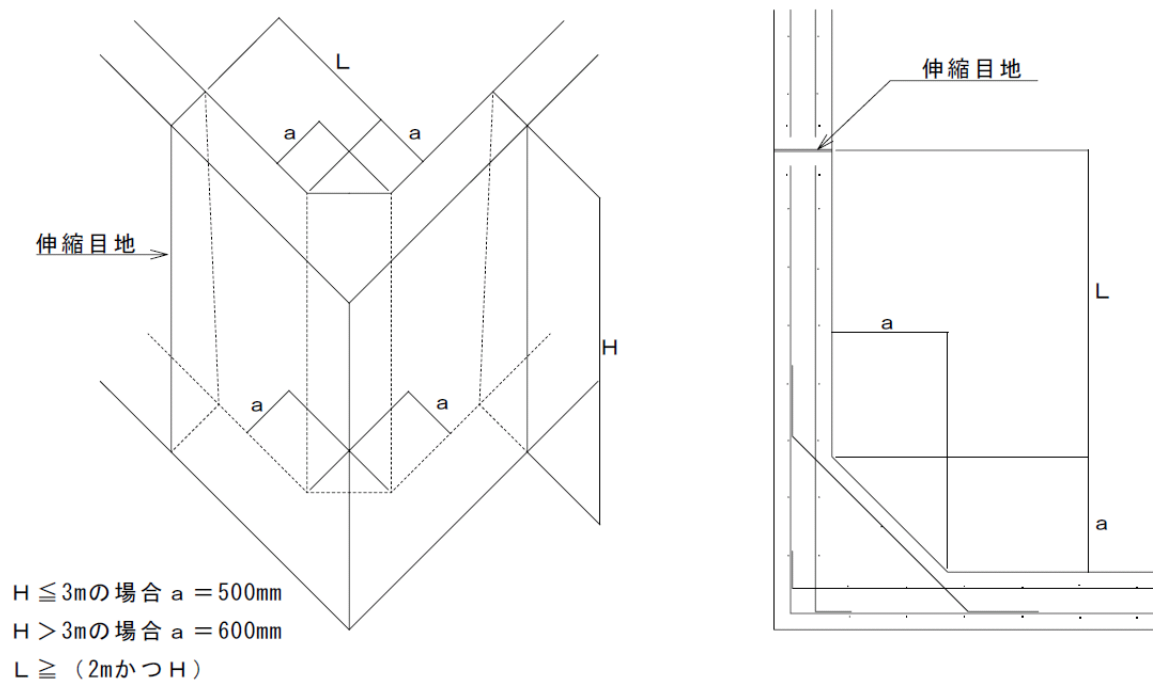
鉄筋コンクリート擁壁の隅角部の補強例
